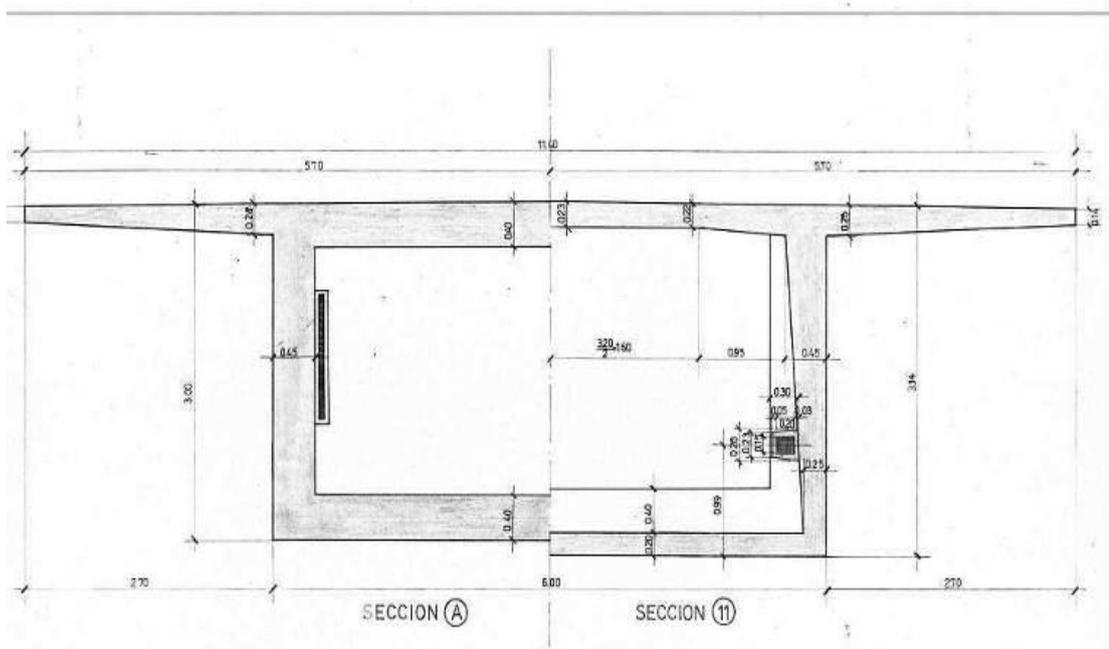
Esquema estático y sección transversal de las vigas principales del sector B del Puente General Artigas
